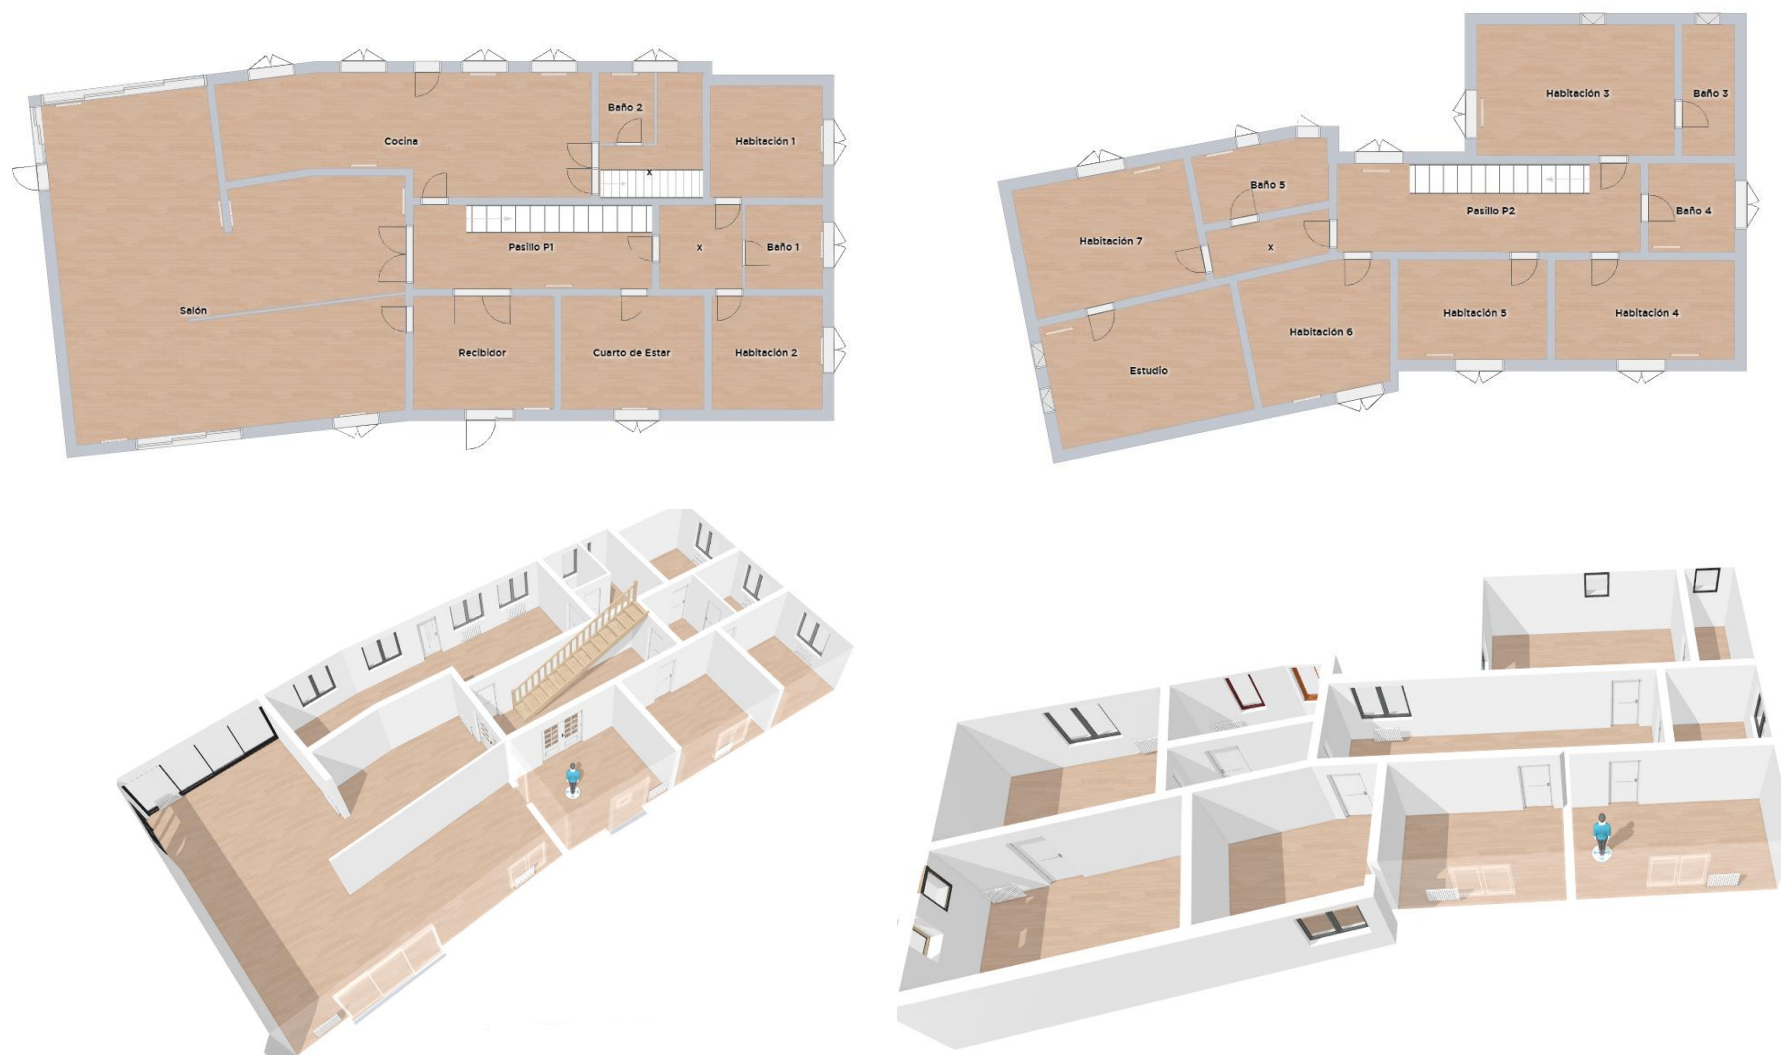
Croquis en planta y en 3D de la primera planta (a la izquierda) y de la segunda planta (a la derecha). (Fuente: Trabajo de Fin de Grado)
